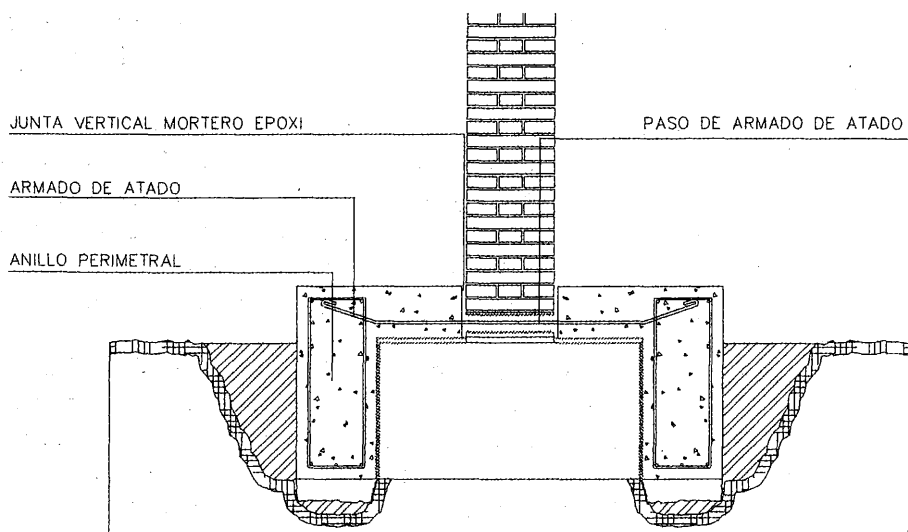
Recalce superficial de zanja corrida aumentando su superficie de apoyo mediante carreras laterales de hormigón armado unidas por armaduras de atado superior.
